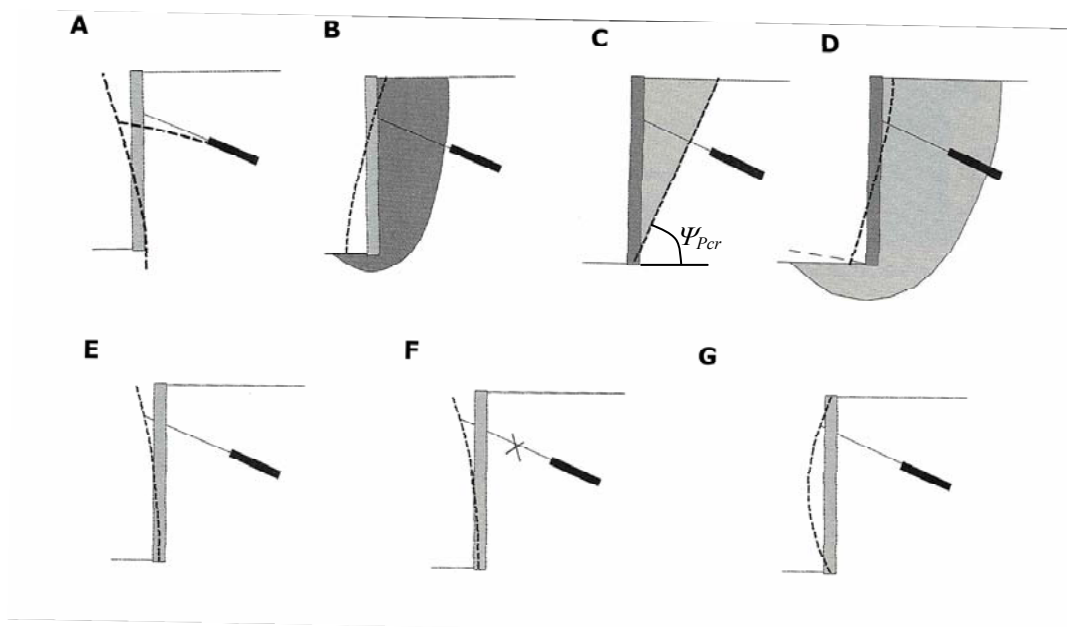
Principali meccanismi di rottura per muri tirantati. A) Rottura al piede per cedimento del terreno di fondazione; B) rottura alla base per la presenza a fondo scavo di terreni di bassa resistenza; C) rottura per cuneo; D) rottura generalizzata; E) rottura per eccessiva deformazione della struttura; F) rottura dell'ancoraggio; G) rottura del muro (da ORTIGAO & SAYAO, 2004) -
